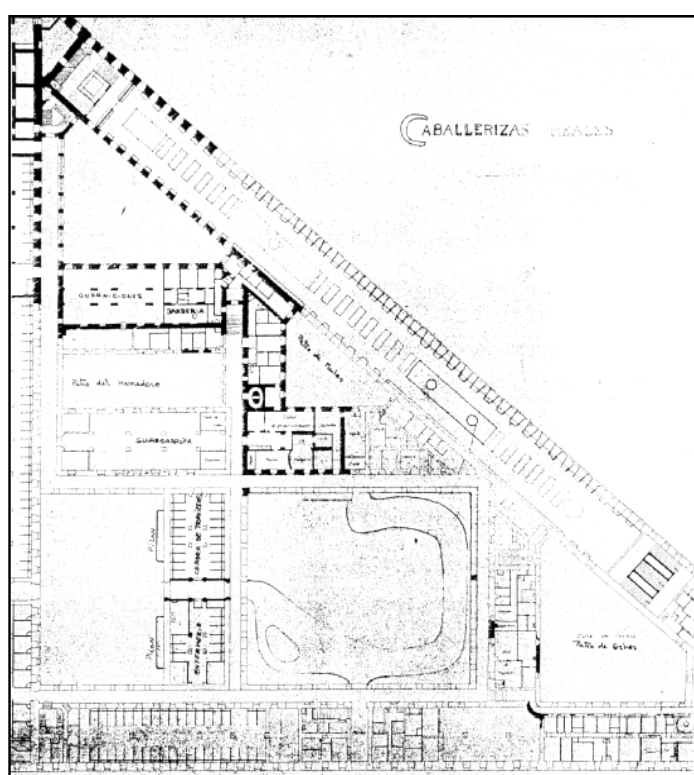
Planta baja de la nueva Real Caballeriza, con entrada principal por la Calle de Bailén.
